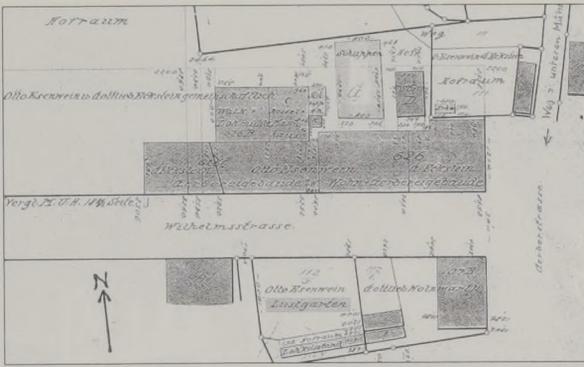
Lageplan von 1887 mit den eingetretenen Grundstücks- und Gebäude-Veränderungen gegenüber dem Plan von 1875.
